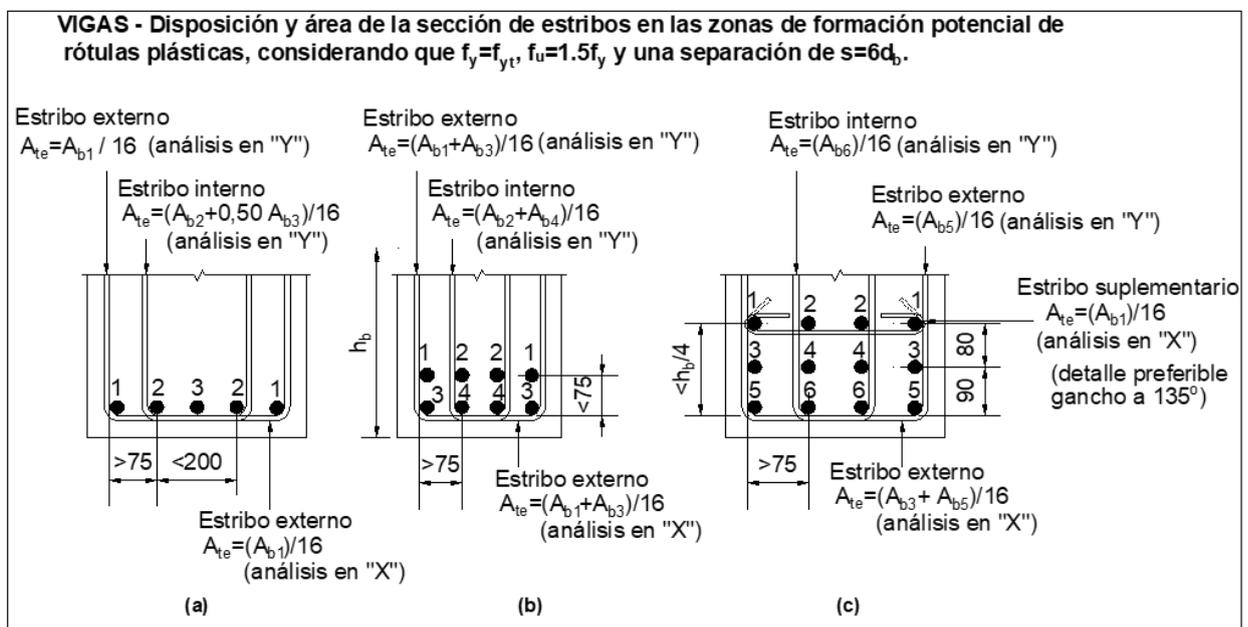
Disposición y áreas de sección de estribos y estribos suplementarios en zona potencial de rótulas plásticas en vigas. Casos de cinco y cuatro barras por capa, y hasta tres capas
